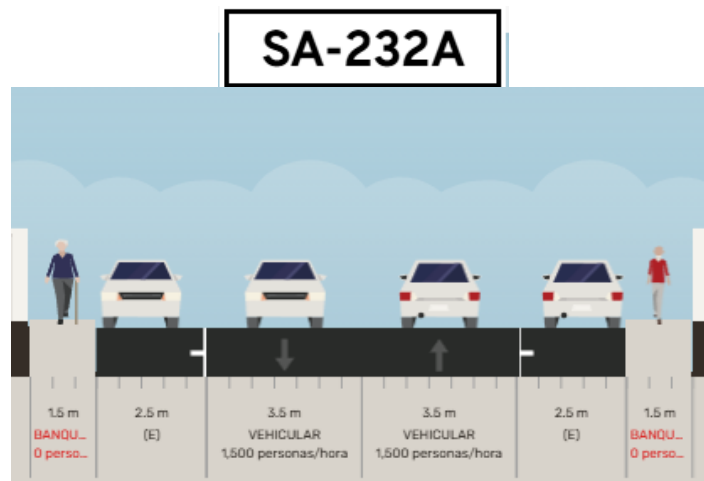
Sección vial de Av. Transformación. Fuente: PDU2040
